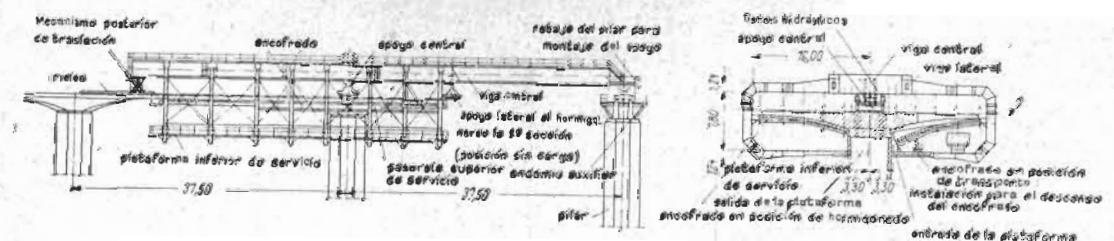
Puente del Elz; cimbra para construcción progresiva.
